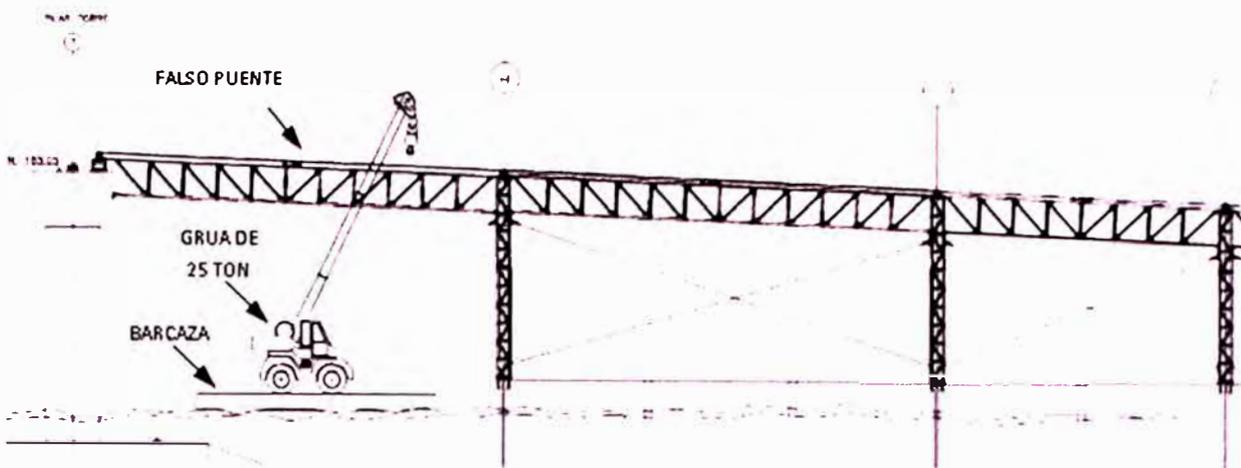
VISTA FRONTAL MONTAJE FALSO PUENTE
